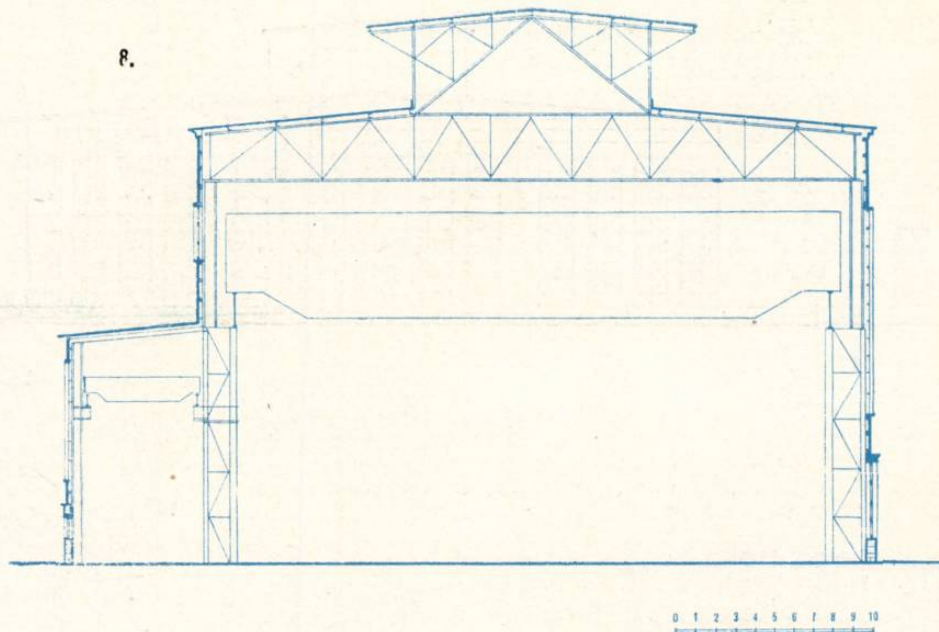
Secțiune transversală. Schemă de montaj a scheletului metalic, plăcilor și panourilor pentru acoperiș, plăcilor pentru pereții verticali și ferestrelor prefabricate din beton armat.
